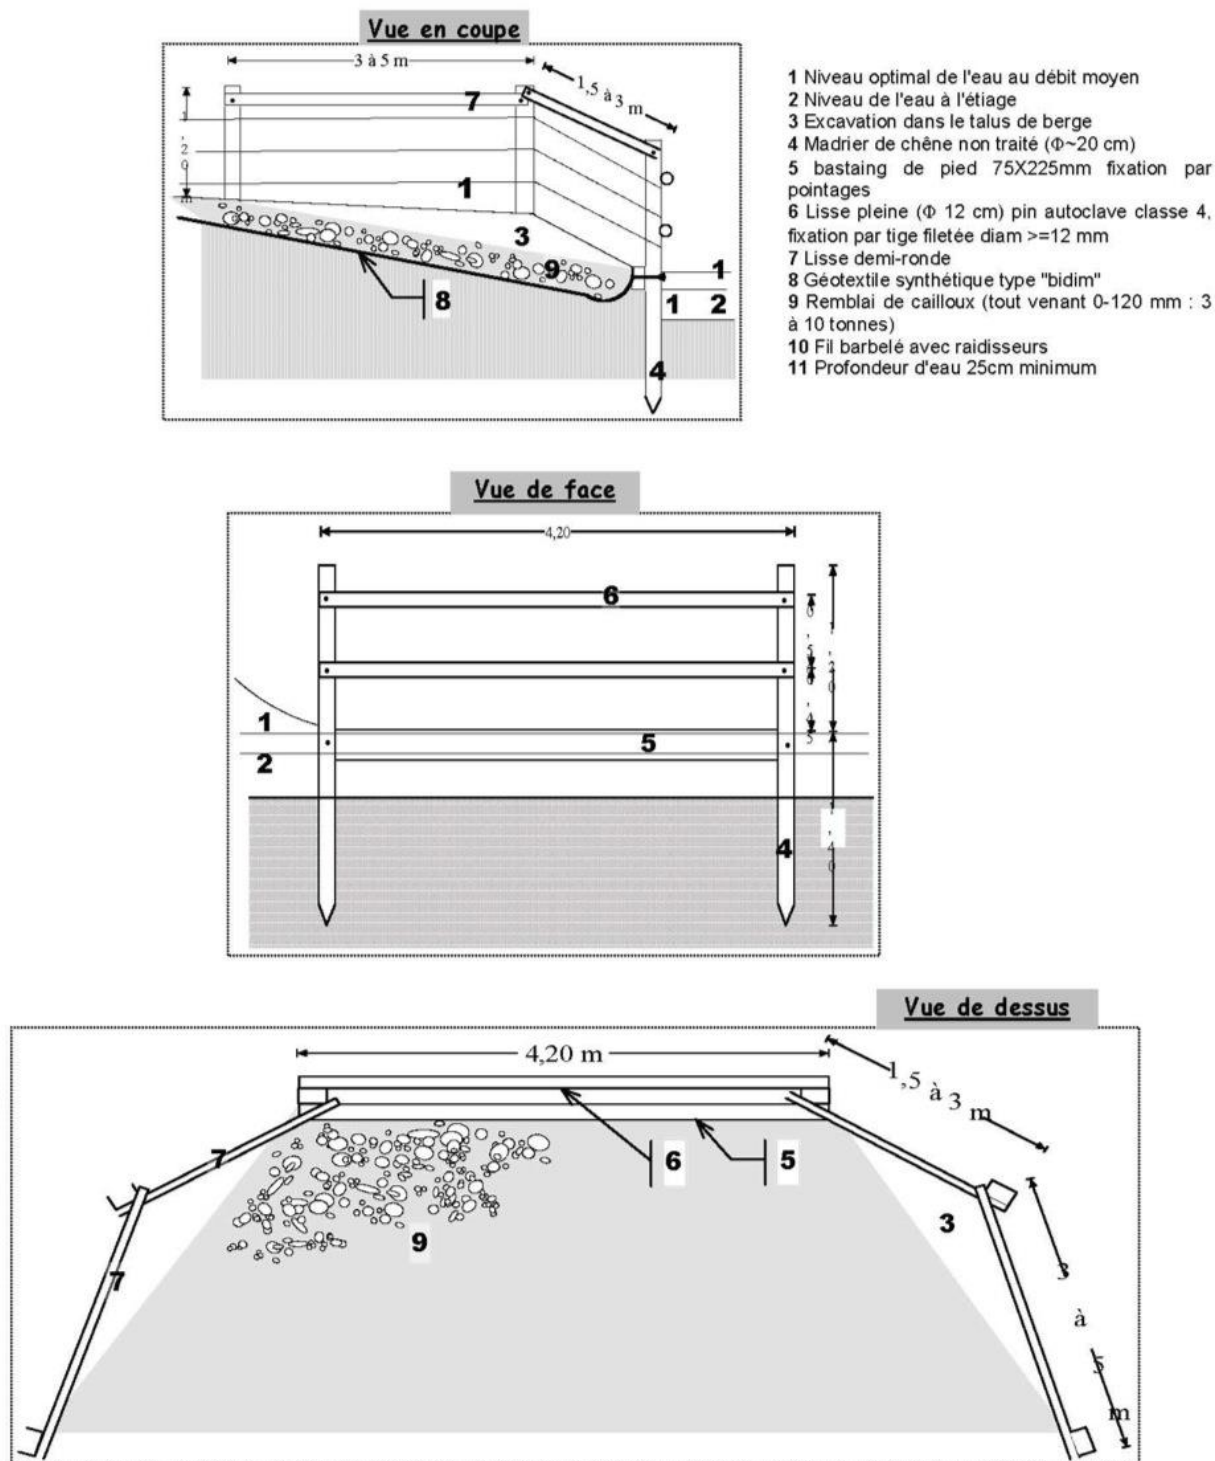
Plans et coupes d'un abreuvoir aménagé
